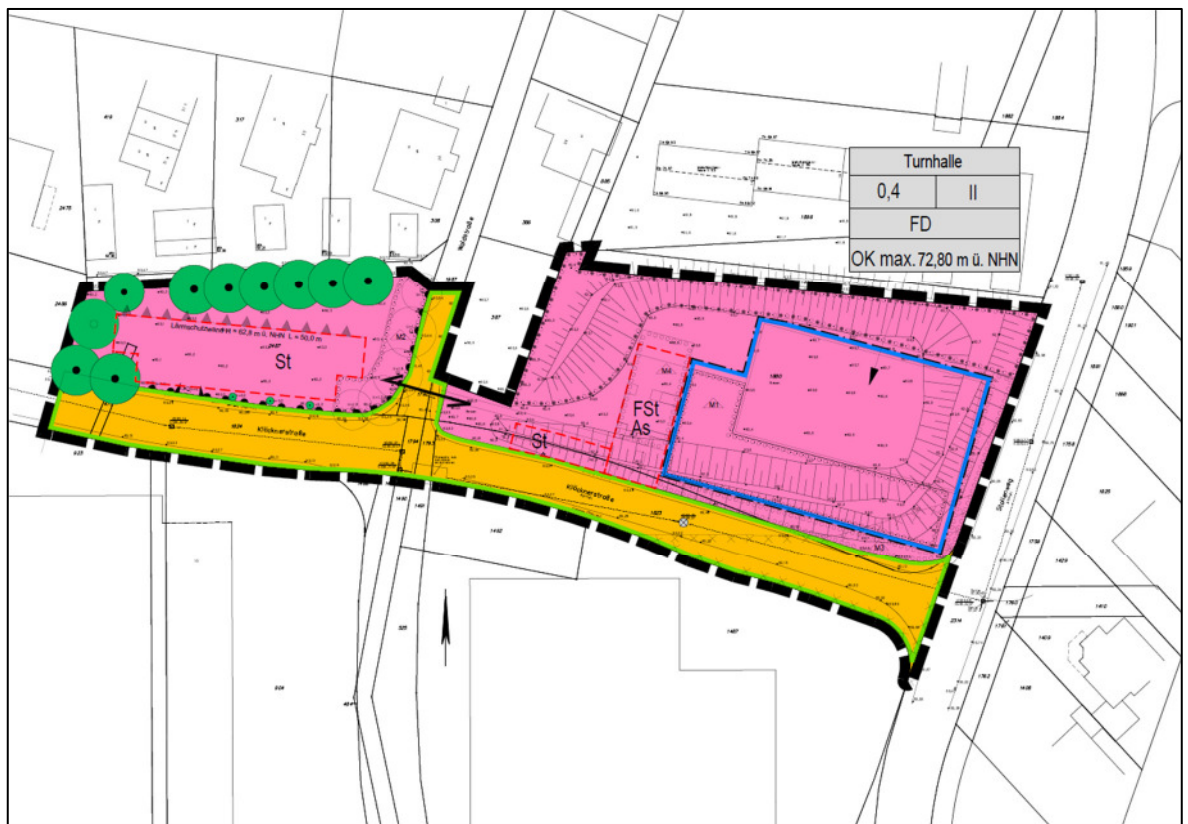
Bebauungsplan 4E - Turnhalle Klöcknerstraße - der Stadt Werne, Stand 16.01.2024 [1]
